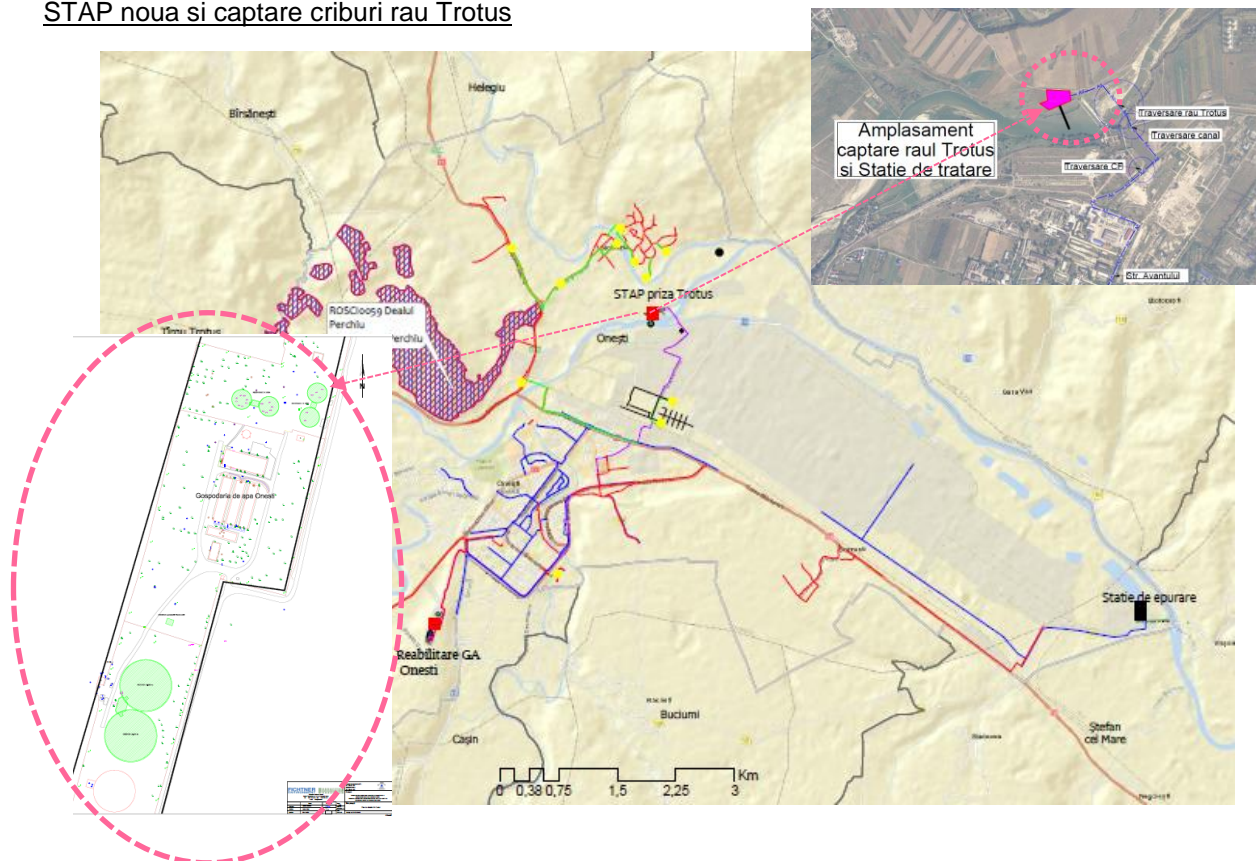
5: Plan de încadrare în zonă – STAP noua Onești priza Trotus
